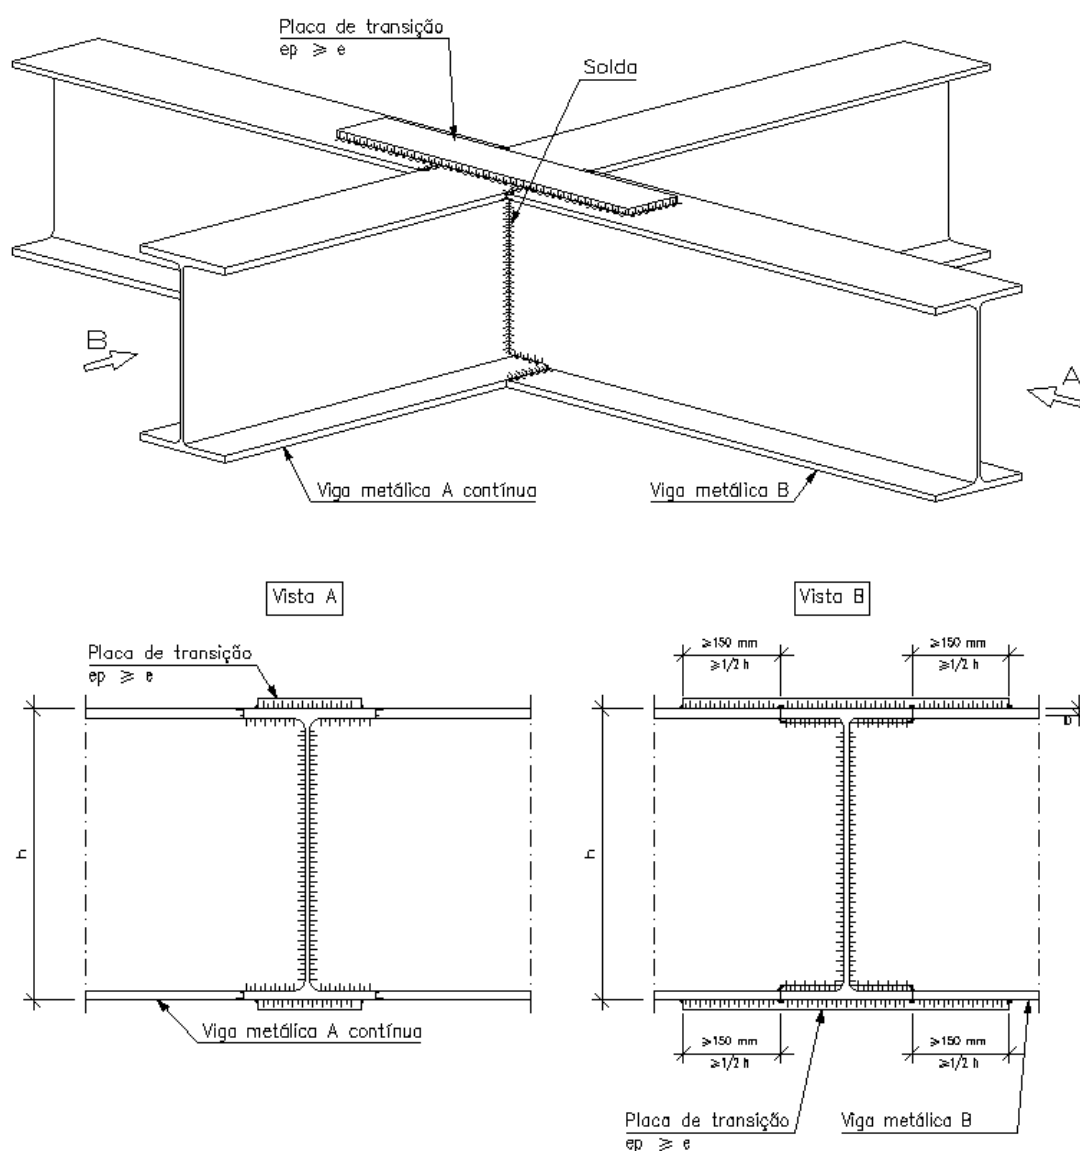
Ligações típicas para pórticos semirrígidos metálicos
